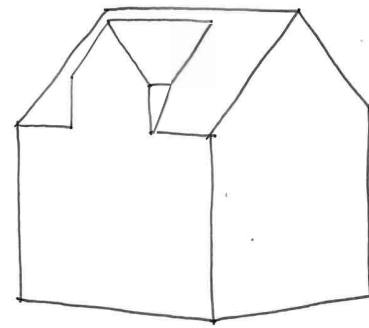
Zwerchhaus mit Satteldach; dessen First verläuft quer zum Dachfirst des Hauptdachs.
